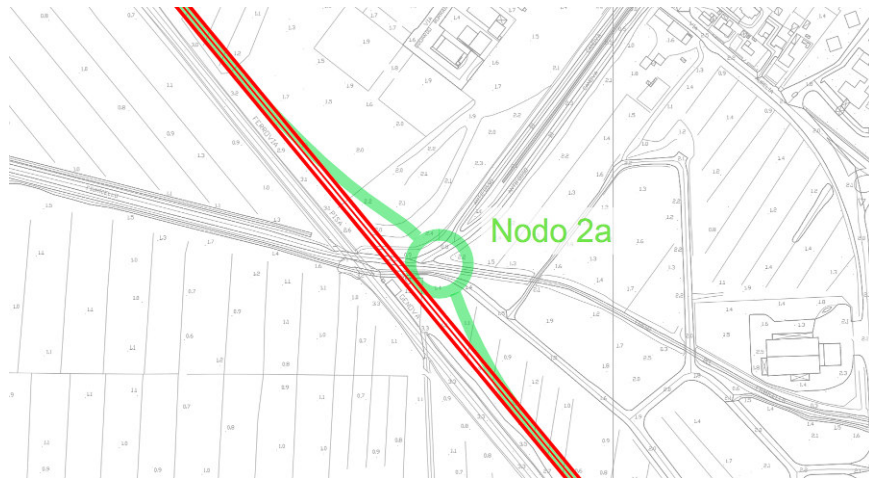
Planimetria di dettaglio ex Nodo 2a
